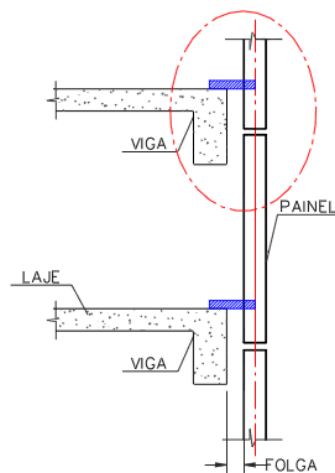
Esquema genérico da fixação dos painéis na estrutura
